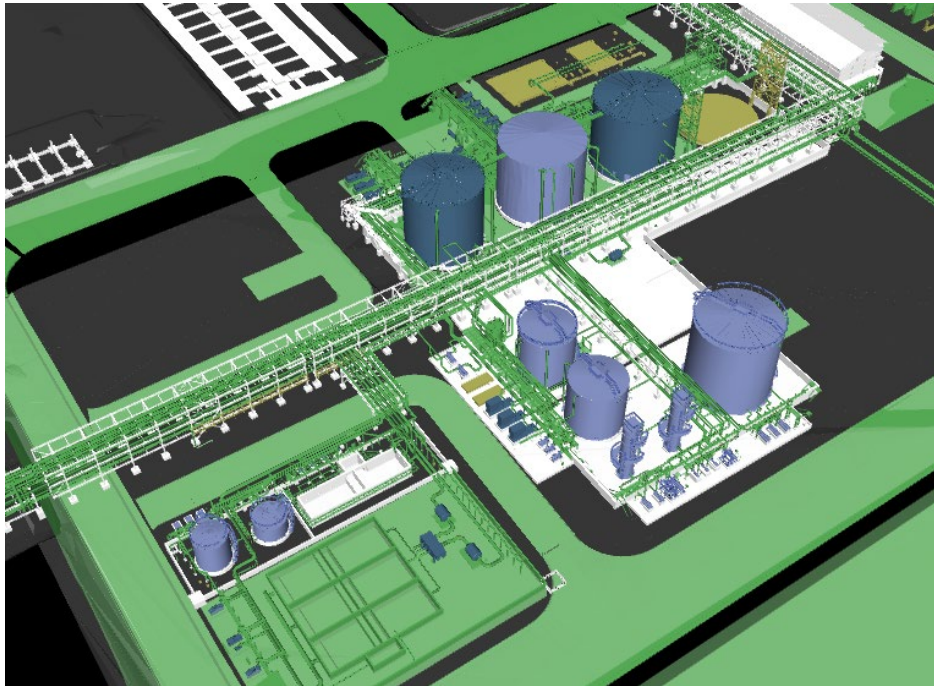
Área de la planta donde se ve el sistema de bombas modelado en OpenPlant.
